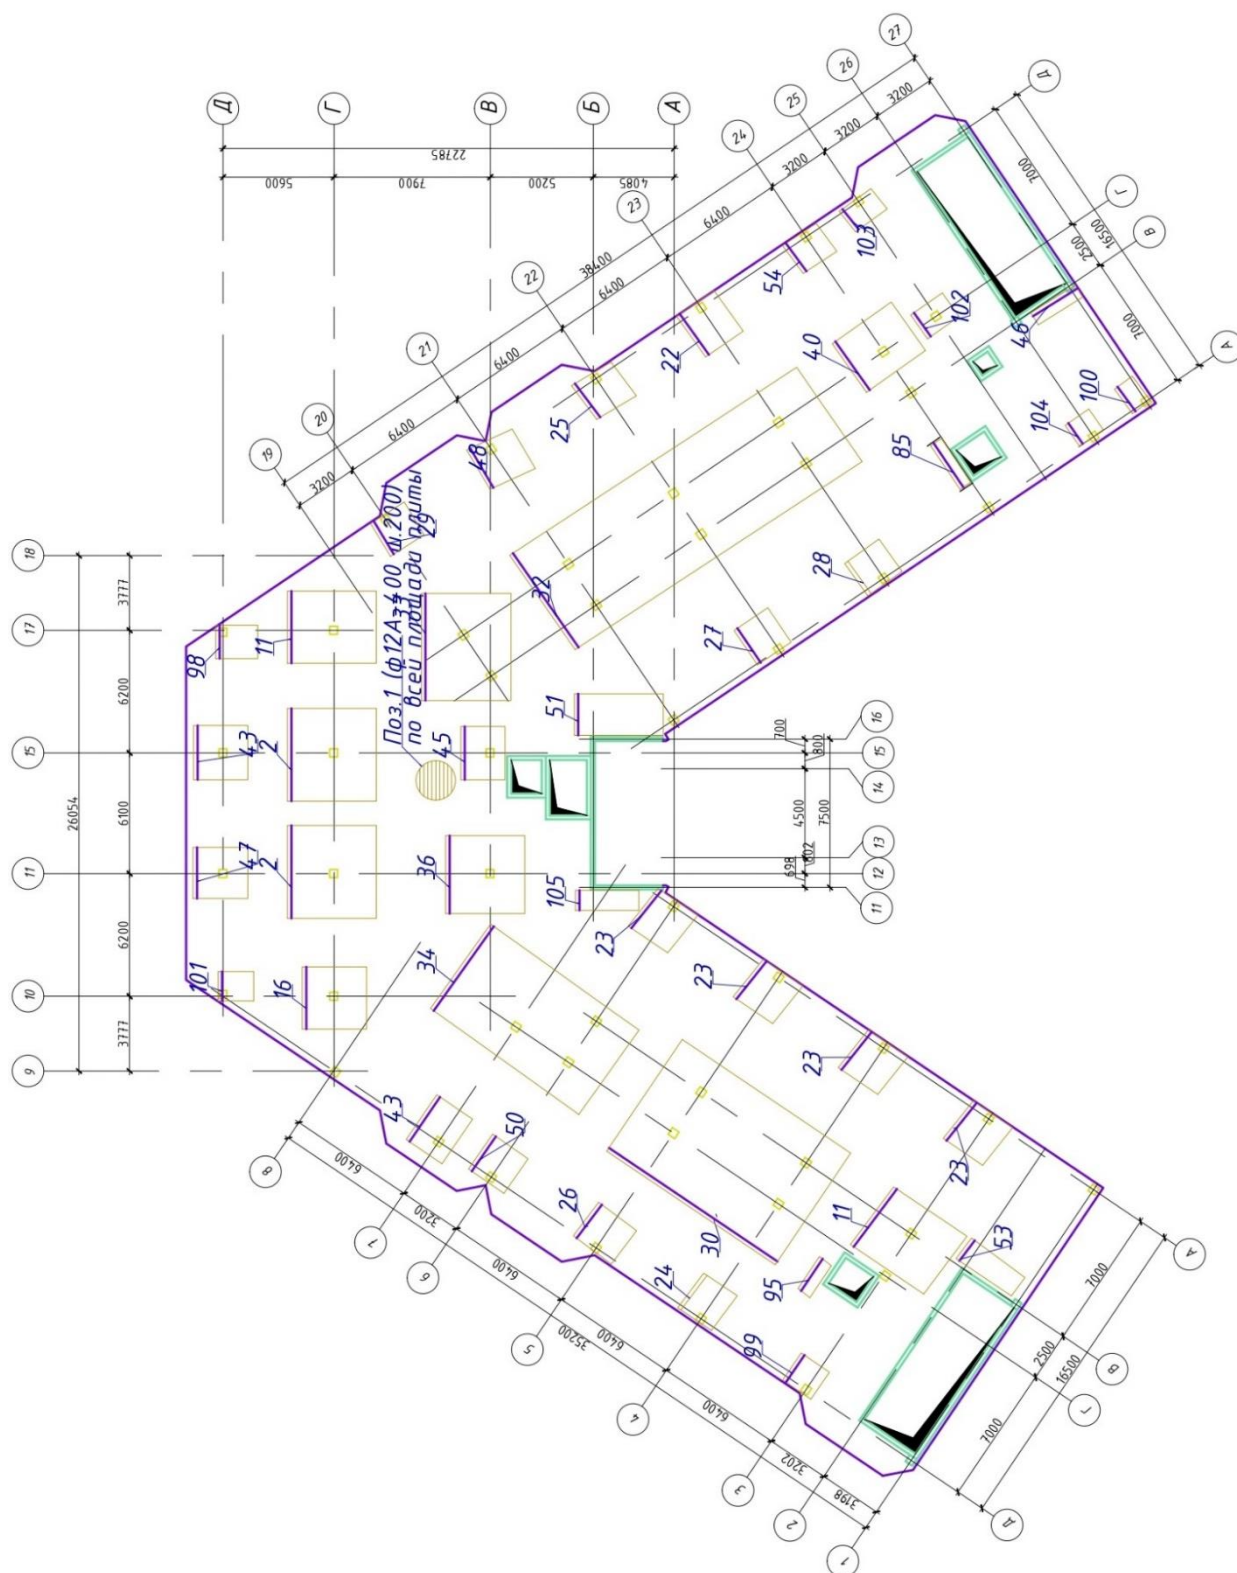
Схема расположения верхней арматуры вдоль цифровых осей плиты перекрытия ПМ – 1 на отметке +9,000
